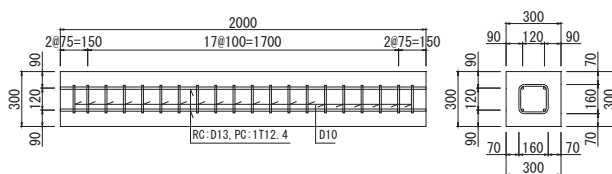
試験体形状 (中型試験体) (No. 1~No. 4)
